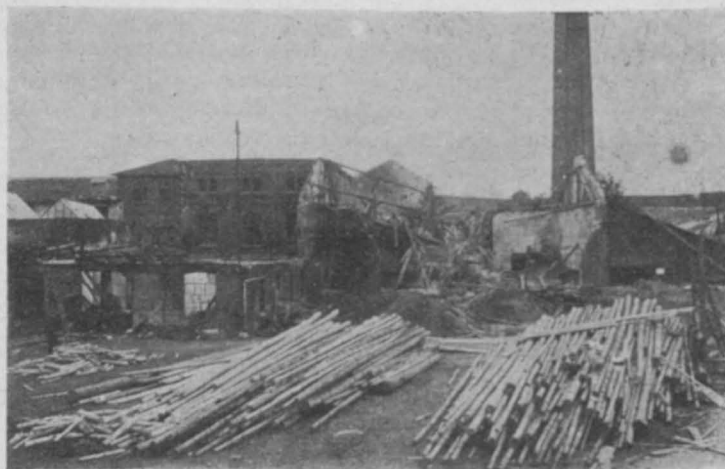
Explosion eines Wasserrohrkessels in Okřisko.
